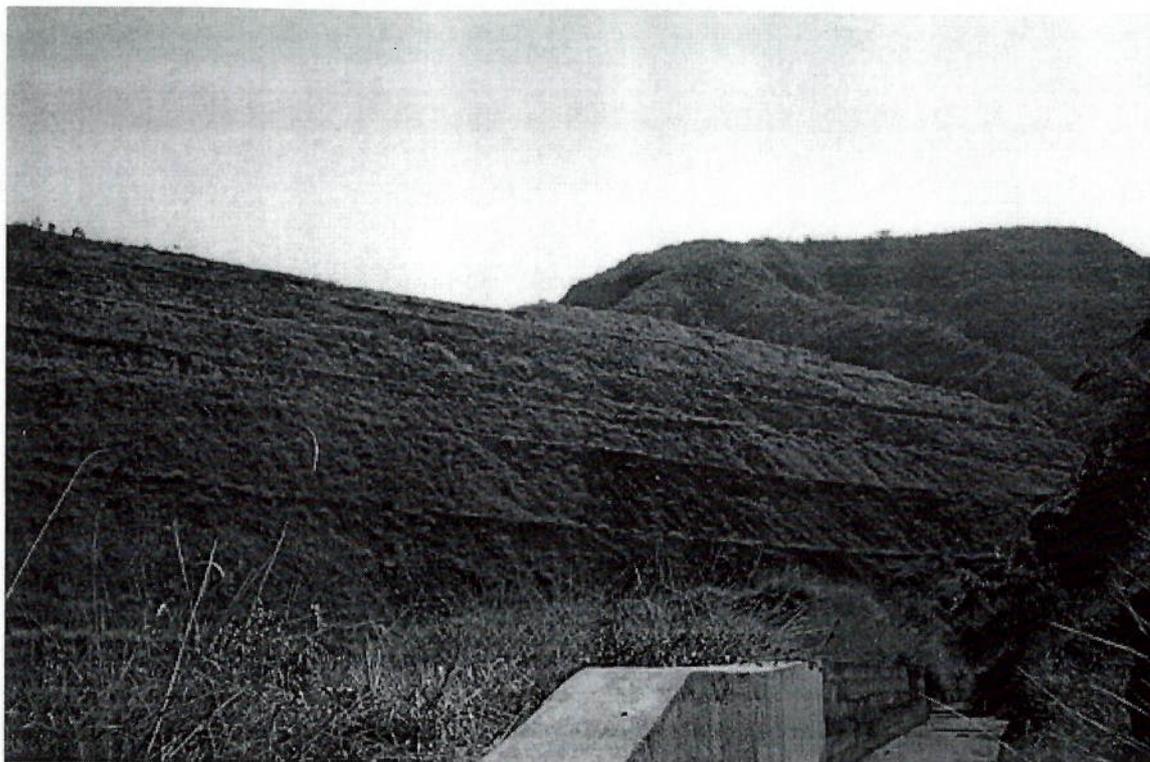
Vista inferior da mesma pilha, com canaleta de drenagem em primeiro plano - Mina de Córrego do Feijão
